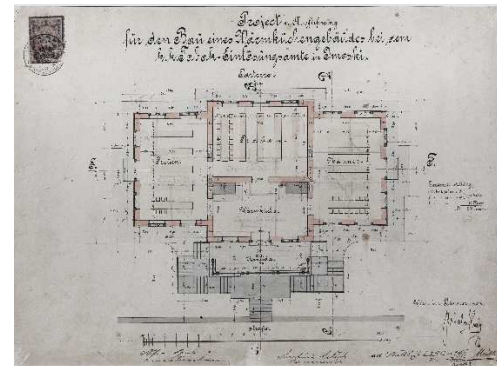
Projekt der Kantine in Imotski, 1903, Grundriss, Erdgeschoss.
